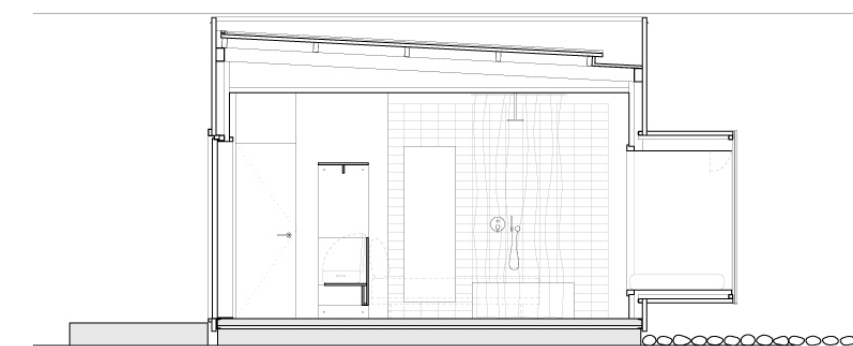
Corte Habitación Hotel Aire de Bardenas, España.
